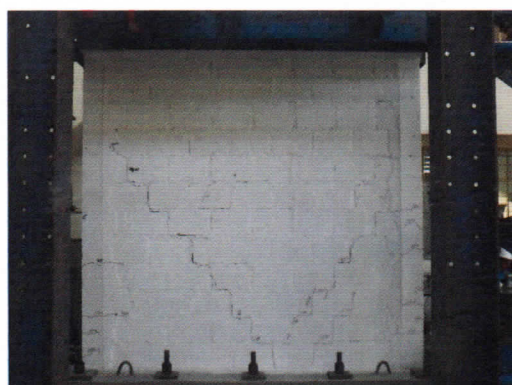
Aparición de grietas de gran extensión en el mortero en las caras Norte y Sur para una distorsión de 1/1100.
